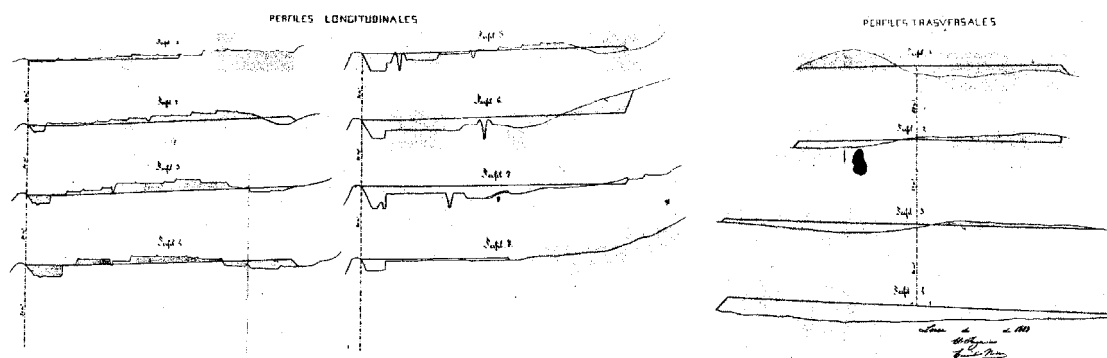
Perfiles del cementerio. Ingeniero Riera. 1888
